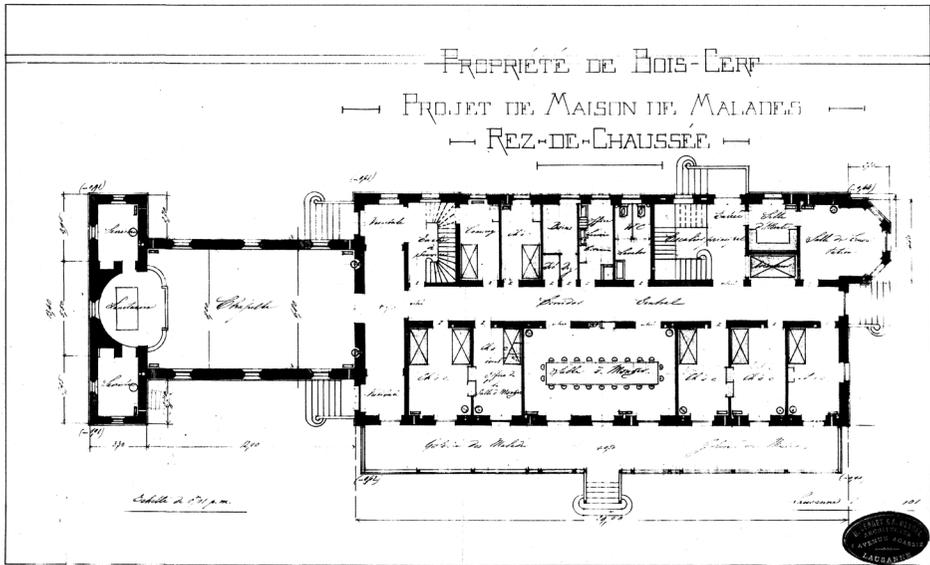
Lausanne, Clinique Bois-Cerf, second projet de plan pour le rez-de-chaussée, 1901 (AVL).
